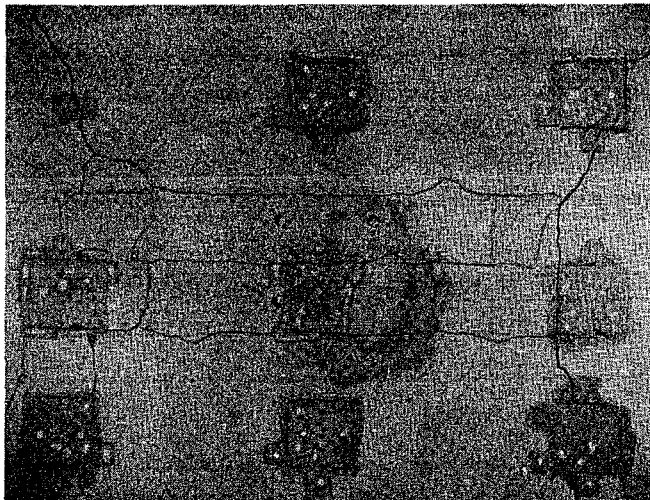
Rissbildung der verputzten Decke A nach dem Bruch.
